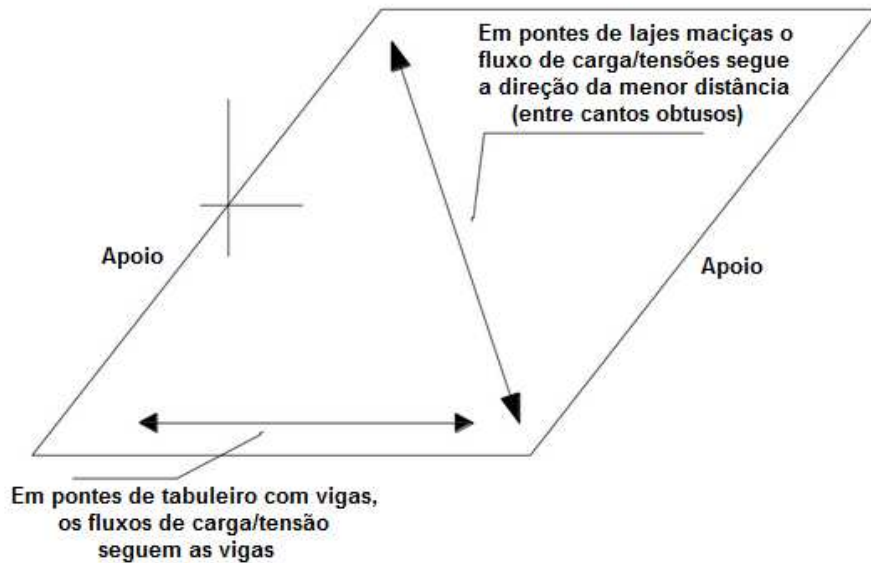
Esquema de distribuição de carga em pontes esbeltas do tipo tabuleiro com vigas e laje maciça (adaptado de AKTAN et ali, 2011)
